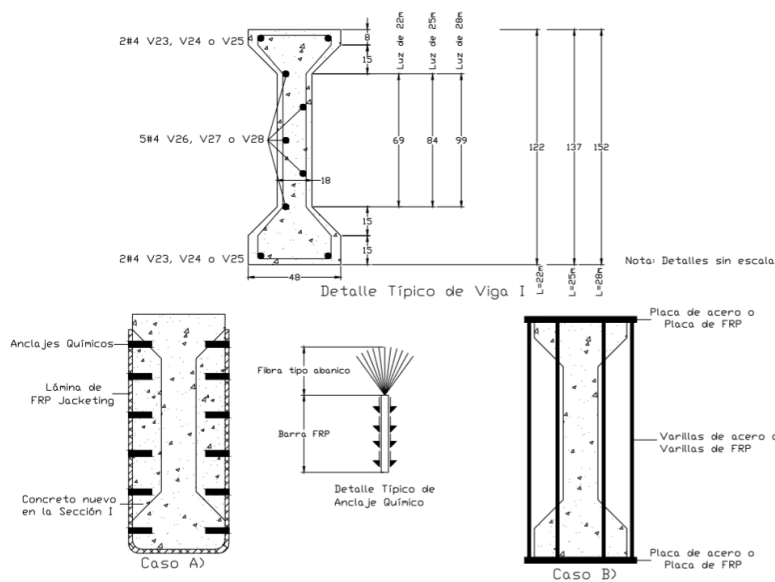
Detalle de una la sección típica de viga I en puentes viga simple de Costa Rica con dos propuestas de reparación para casos de daños por cortante. Fuente: Elaboración propia.
